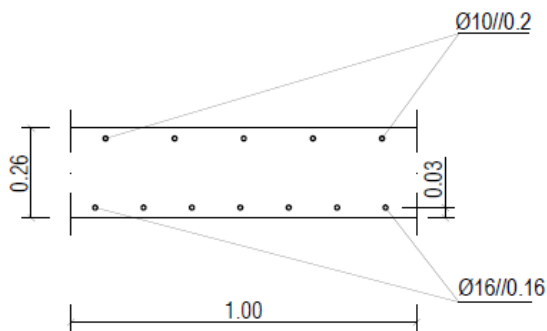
Secção transversal da zona livre para laje simplesmente apoiada
